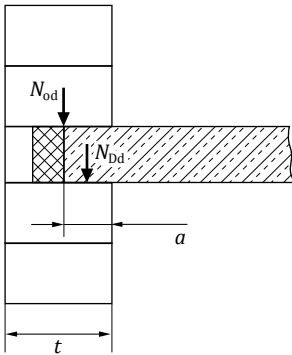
(NA.1). Teilweise aufliegende Deckenplatte
